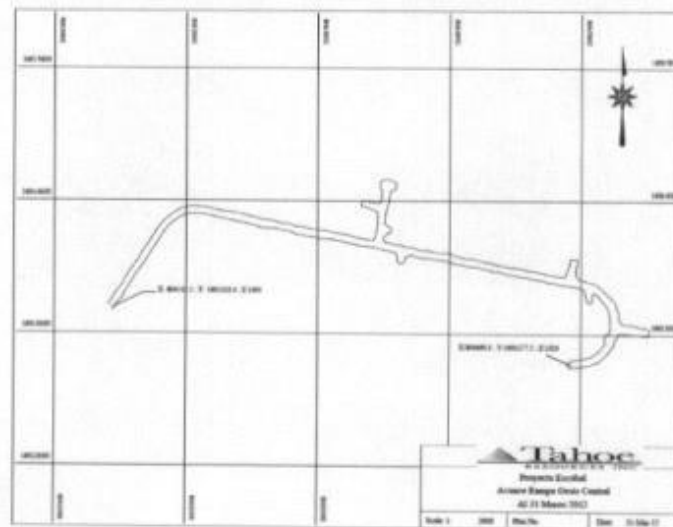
Plano de avance de la rampa Oeste al cierre de este informe.
